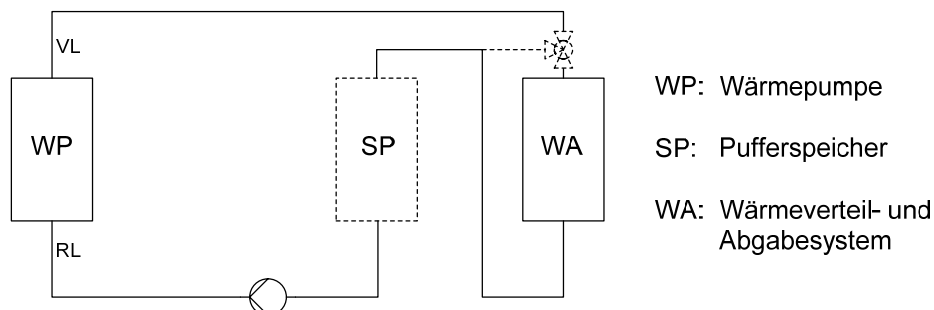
Einbindungsvariante ohne Brauchwarmwasseraufbereitung mittels WP gemäss STASCH-Planungshilfen [27]
